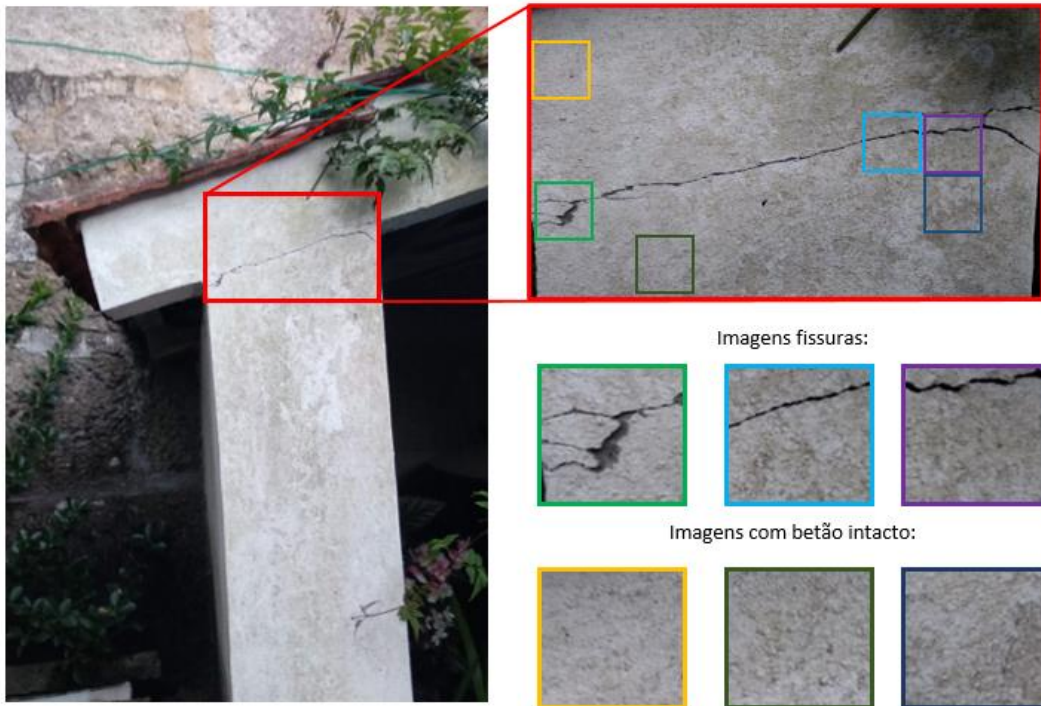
Recolha de imagens de fissuras, Marco de Canaveses
